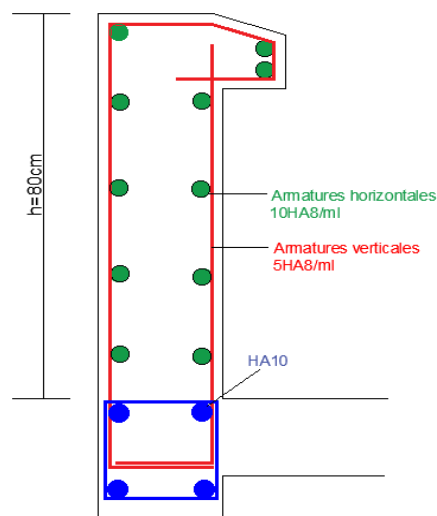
Schéma de ferrailage de l'acrotère selon le CBA 93.
